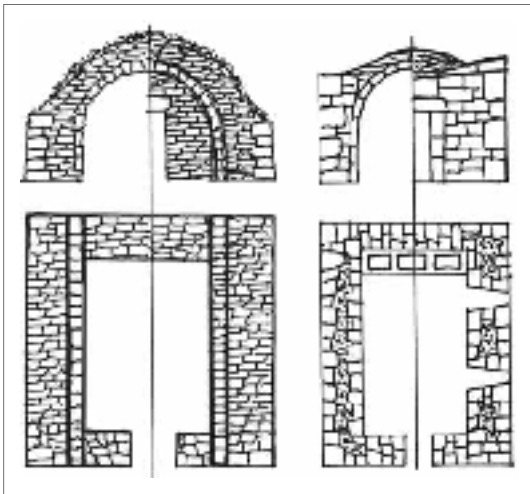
Construcciones de planta rectangular y cerramiento en bóveda
